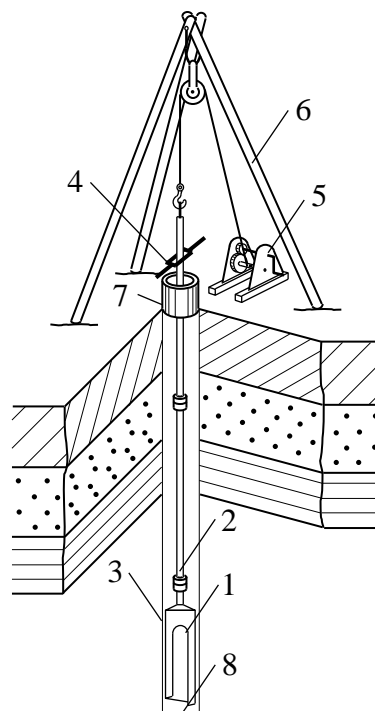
Бурова установка для ручного ударно-обертального буріння: 1 – буровий інструмент; 2 – штанга; 3 – обсадна труба; 4 – хомут; 5 – лебідка; 6 – копер; 7 – устя свердловини; 8 – забій
